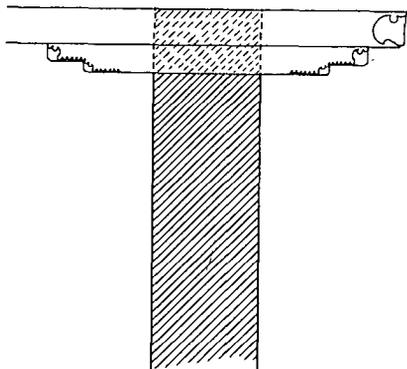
Sección transversal del apoyo de las vigas en el muro.
